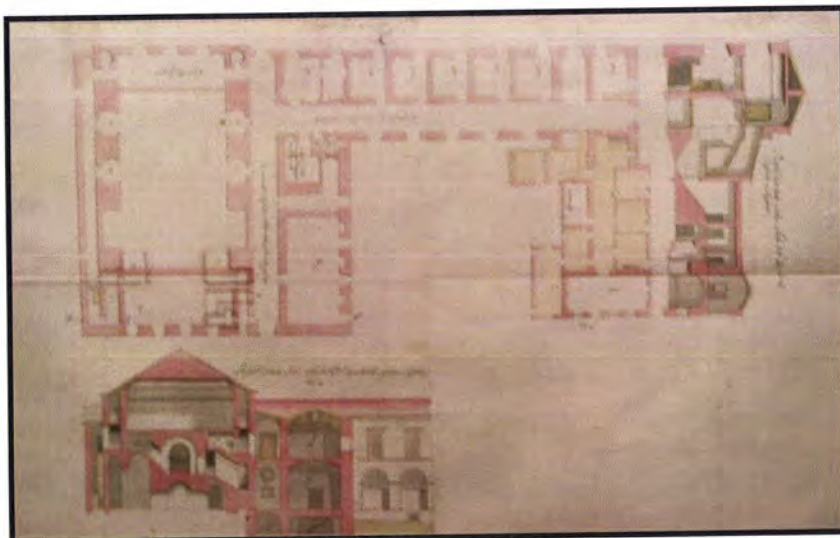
Planta Superior do Colégio de Jesuítas de Portalegre
